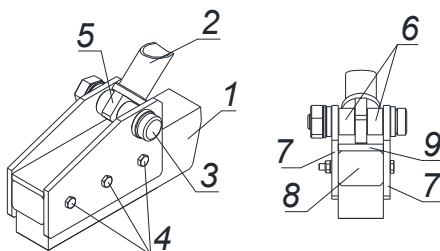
Узел примыкания арки к балке. 1- балка (затяжка); 2- арка; 3- палец; 4- болты; 5- серьга; 6- втулки; 7- боковые щеки; 8- торцевая планка; 9- верхняя планка.
